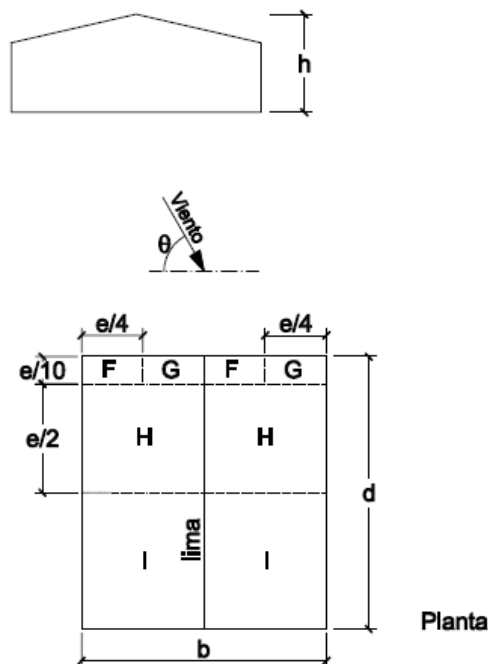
Zonas de la cubierta de fútbol para viento longitudinal.
